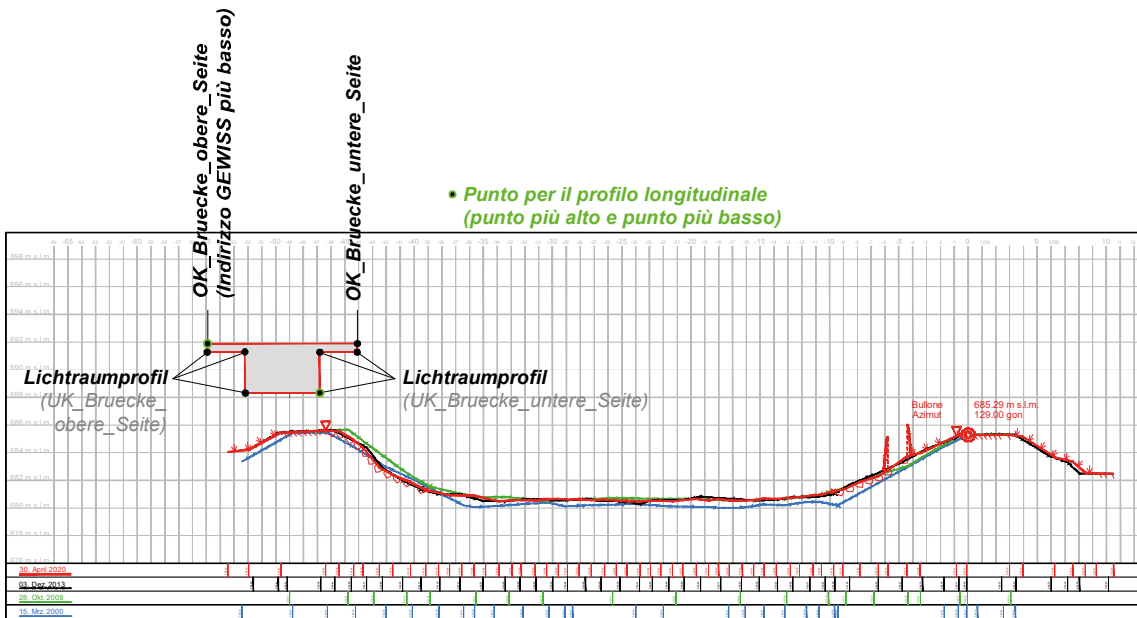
Esempio sezioni di un ponte, profilo trasversale GEWISS-Adr. 218467.
